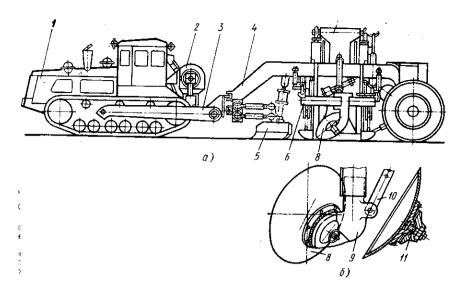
Полуприцепной грейдер-элеватор: а – общий вид; б – рабочий орган; 1 – тягач-трактор Т-180; 2 – генератор; 3 – траверса; 4 – рама; 5 – планировщик; 6 – плужная балка; 7 – ленточный конвейер; 8 – дисковый нож; 9 – дискодержатель; 10 – планка для установки угла резания; 11 – болт крепления диска и гребенчатой шайбы
